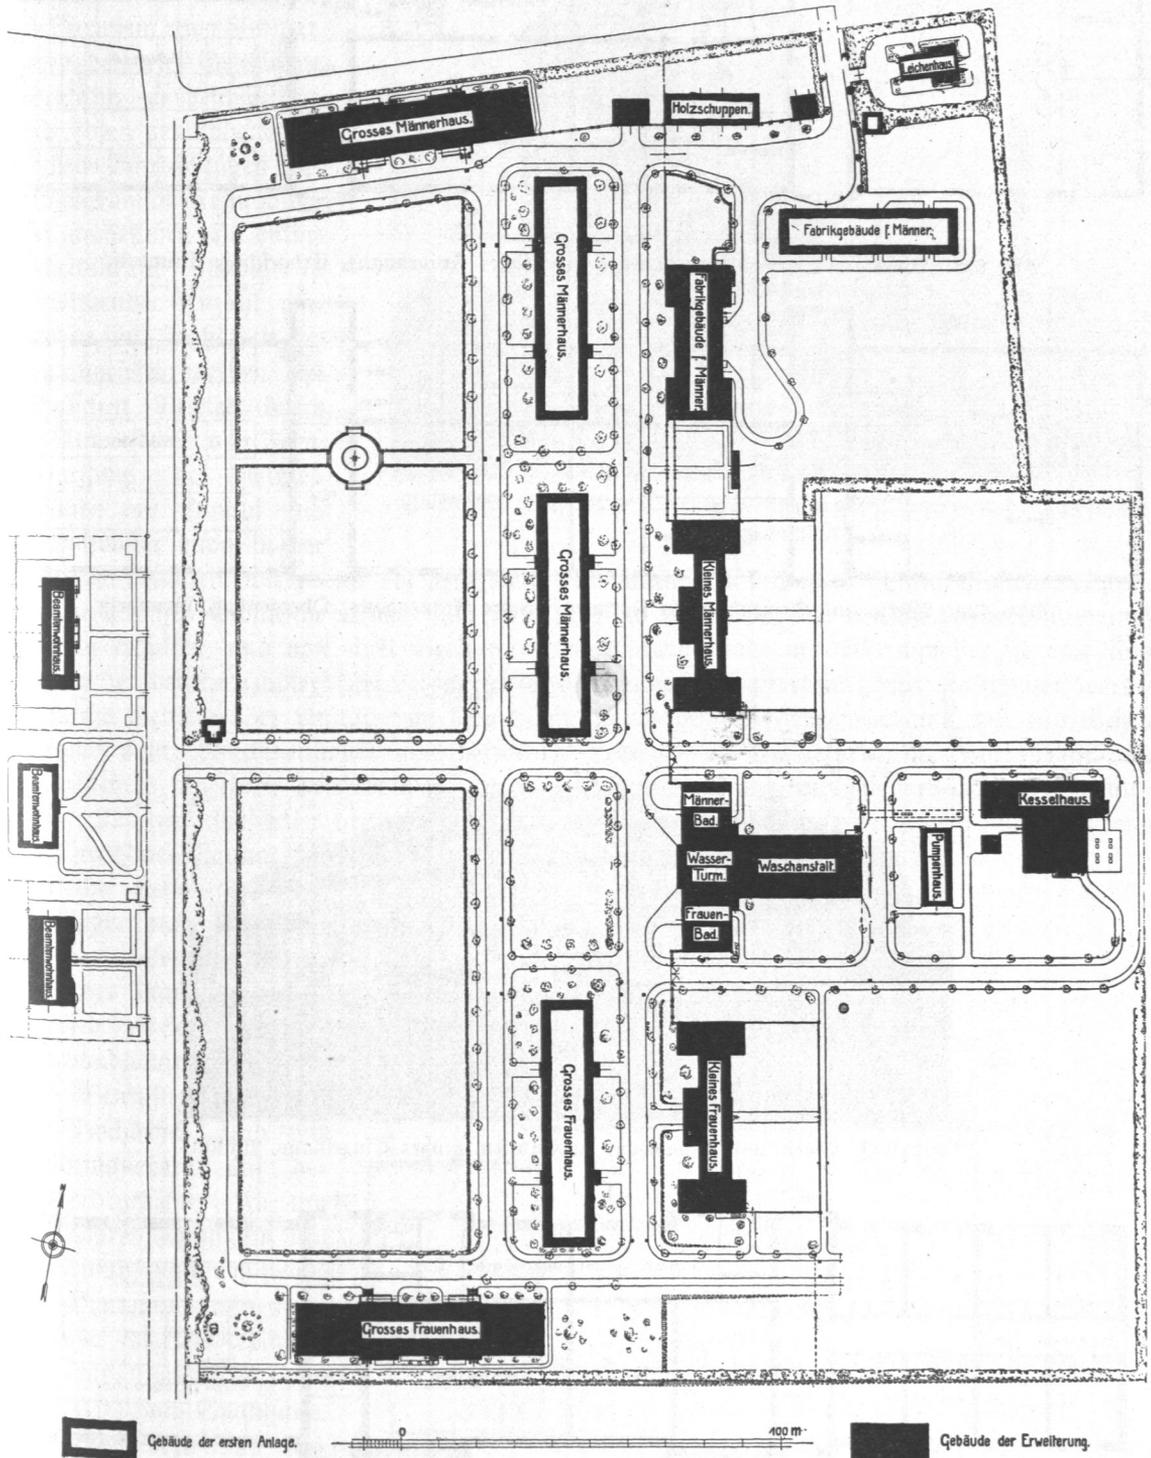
Werk- und Armenhaus in Farmsen, Lageplan.
